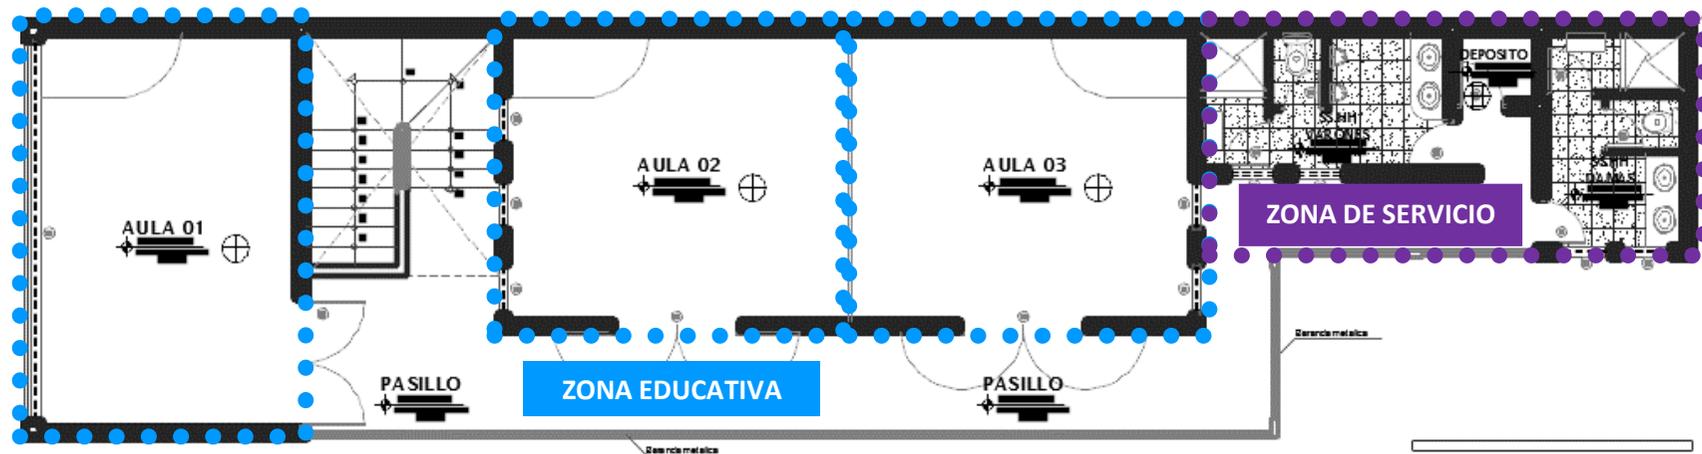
Planta de distribución de Propuesta de Obra nueva del segundo nivel, dividida en zonas educativa y de servicio
